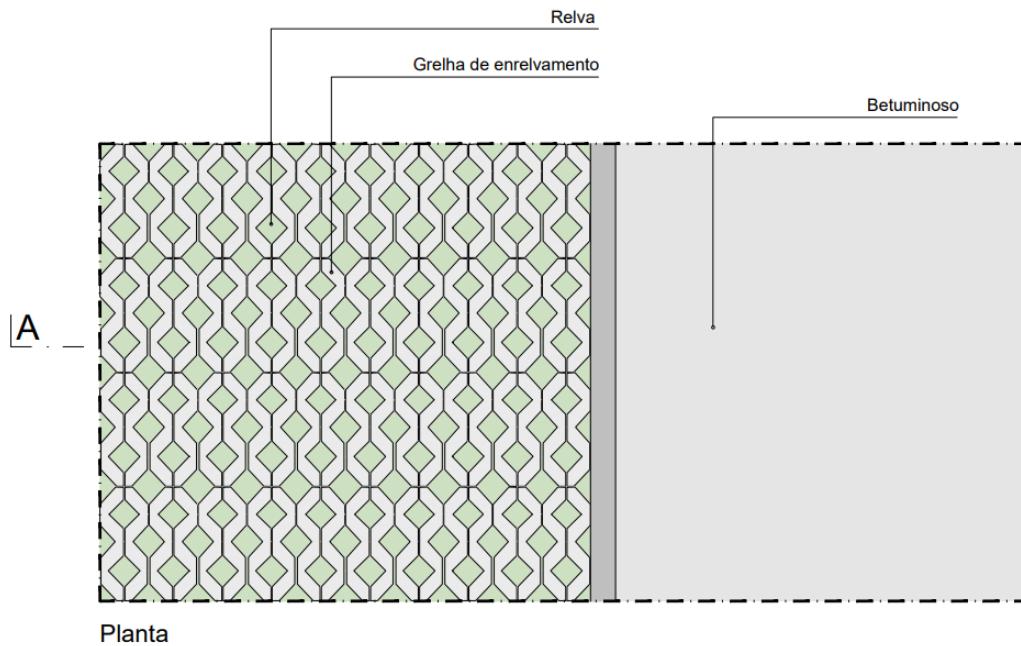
Planta de um pavimento em grelha de enrelvamento. Fonte: (Acioli, 2005).
